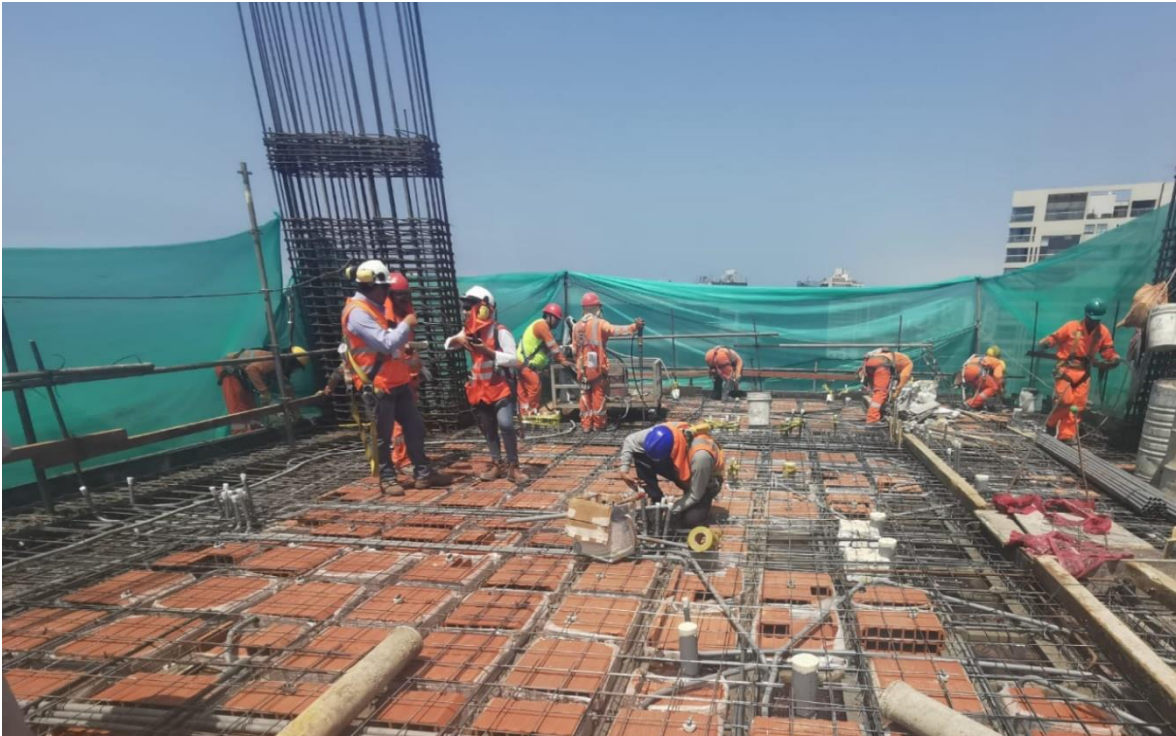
Canalizado de tuberías PVC y cajas de f°g° en columnas de concreto
